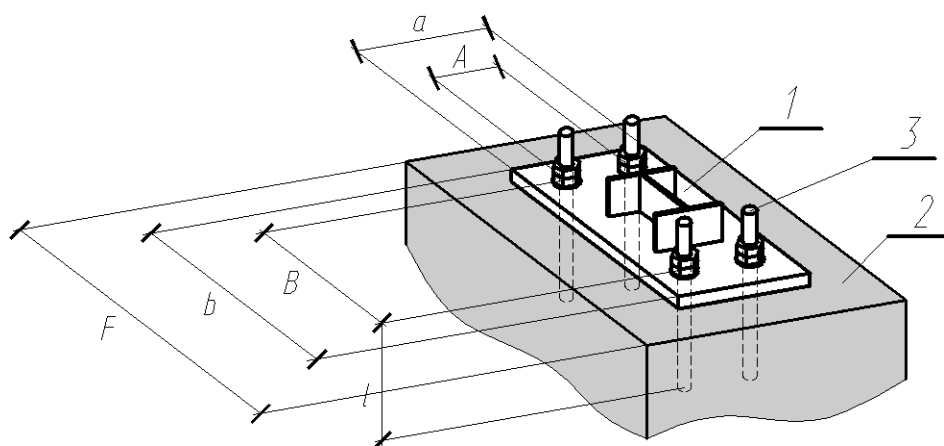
Крепление стойки экрана на фундаментные болты:
